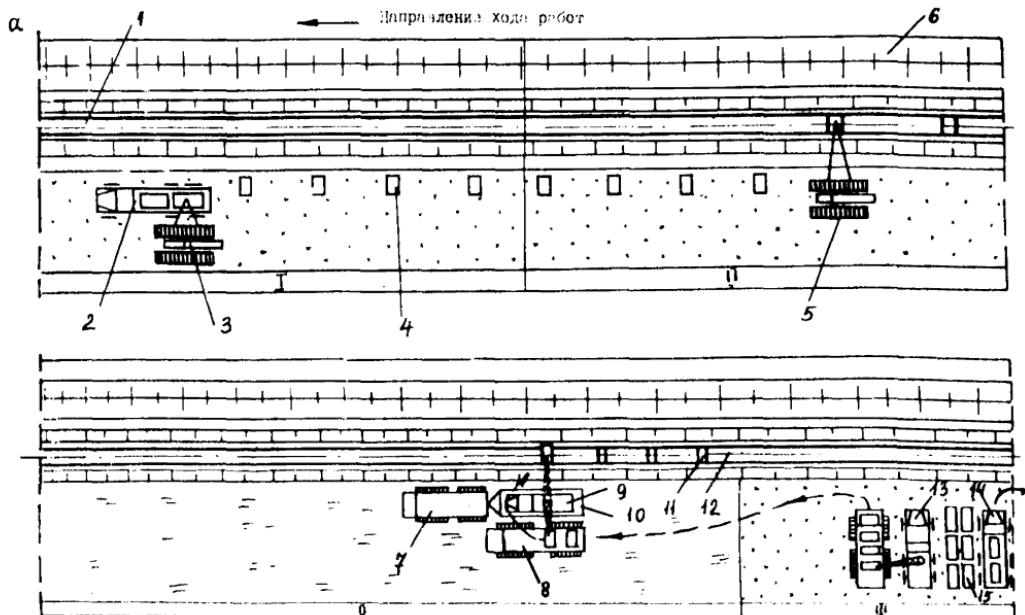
Схема организации работ по балластировке трубопровода утяжеляющими железобетонными грузами:
